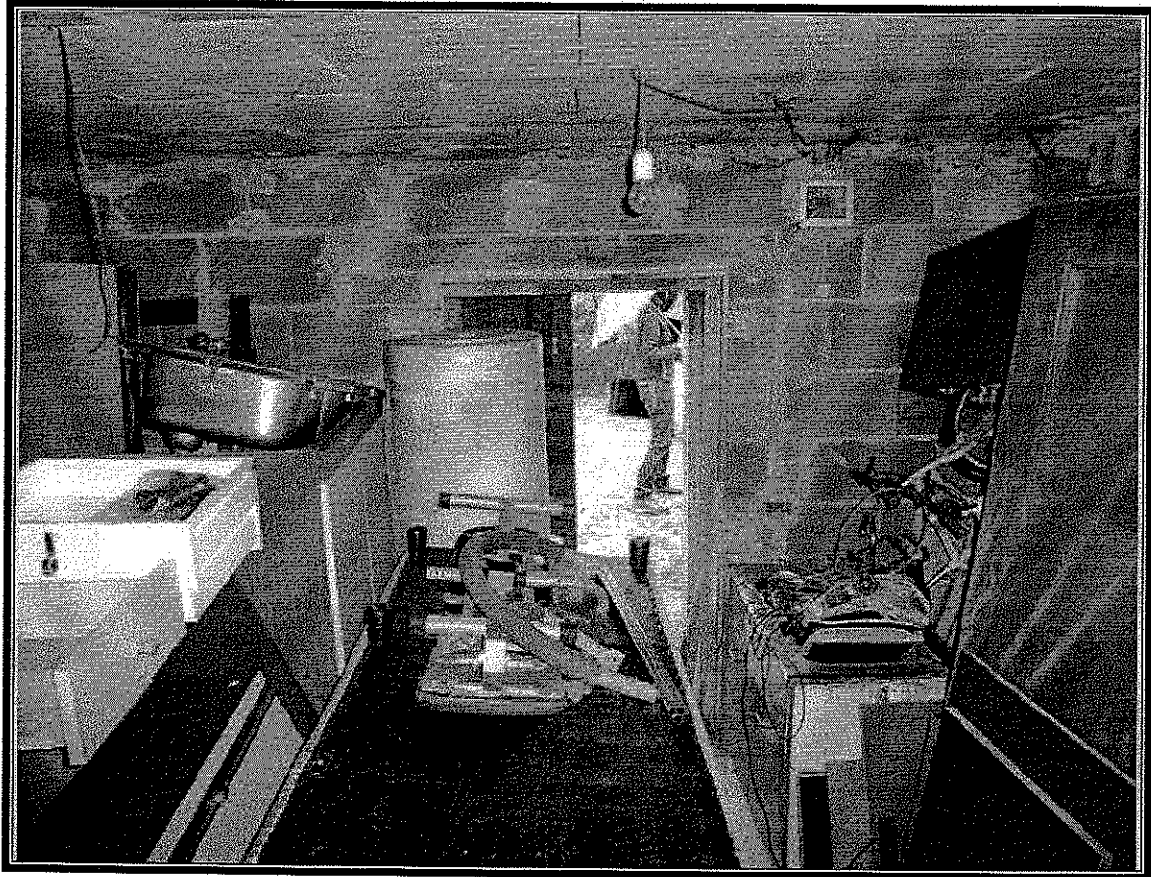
locale bagno – 1<sup>^</sup> piano
